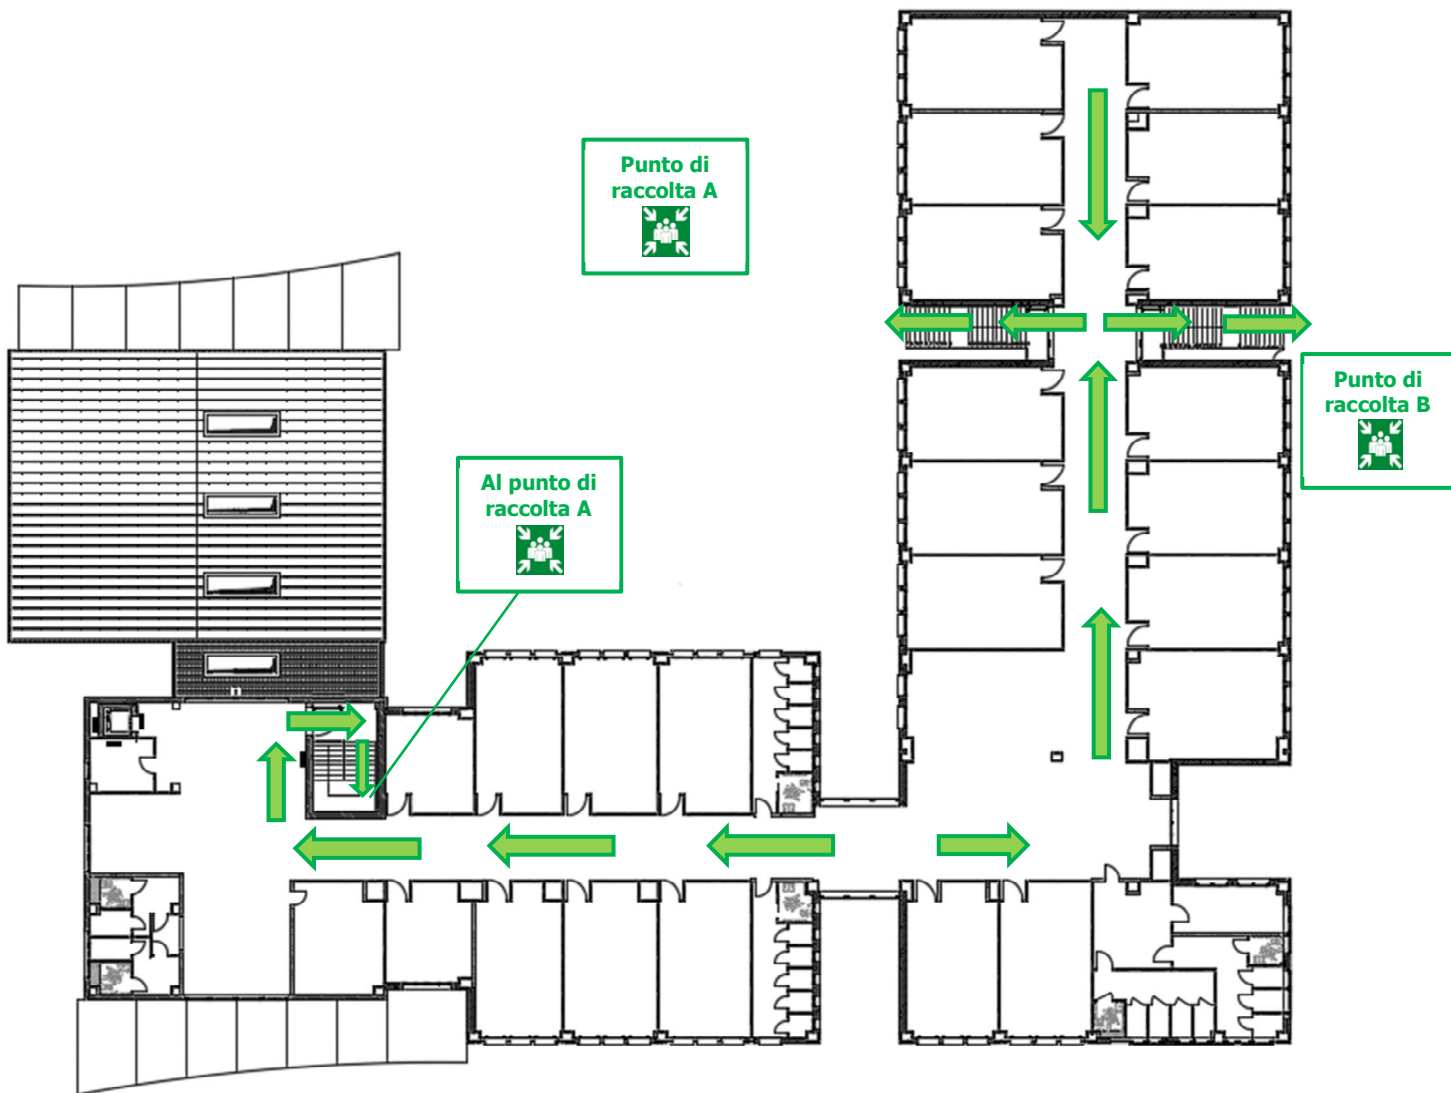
Planimetria Piano Primo Scuola (orientamento N-S)
